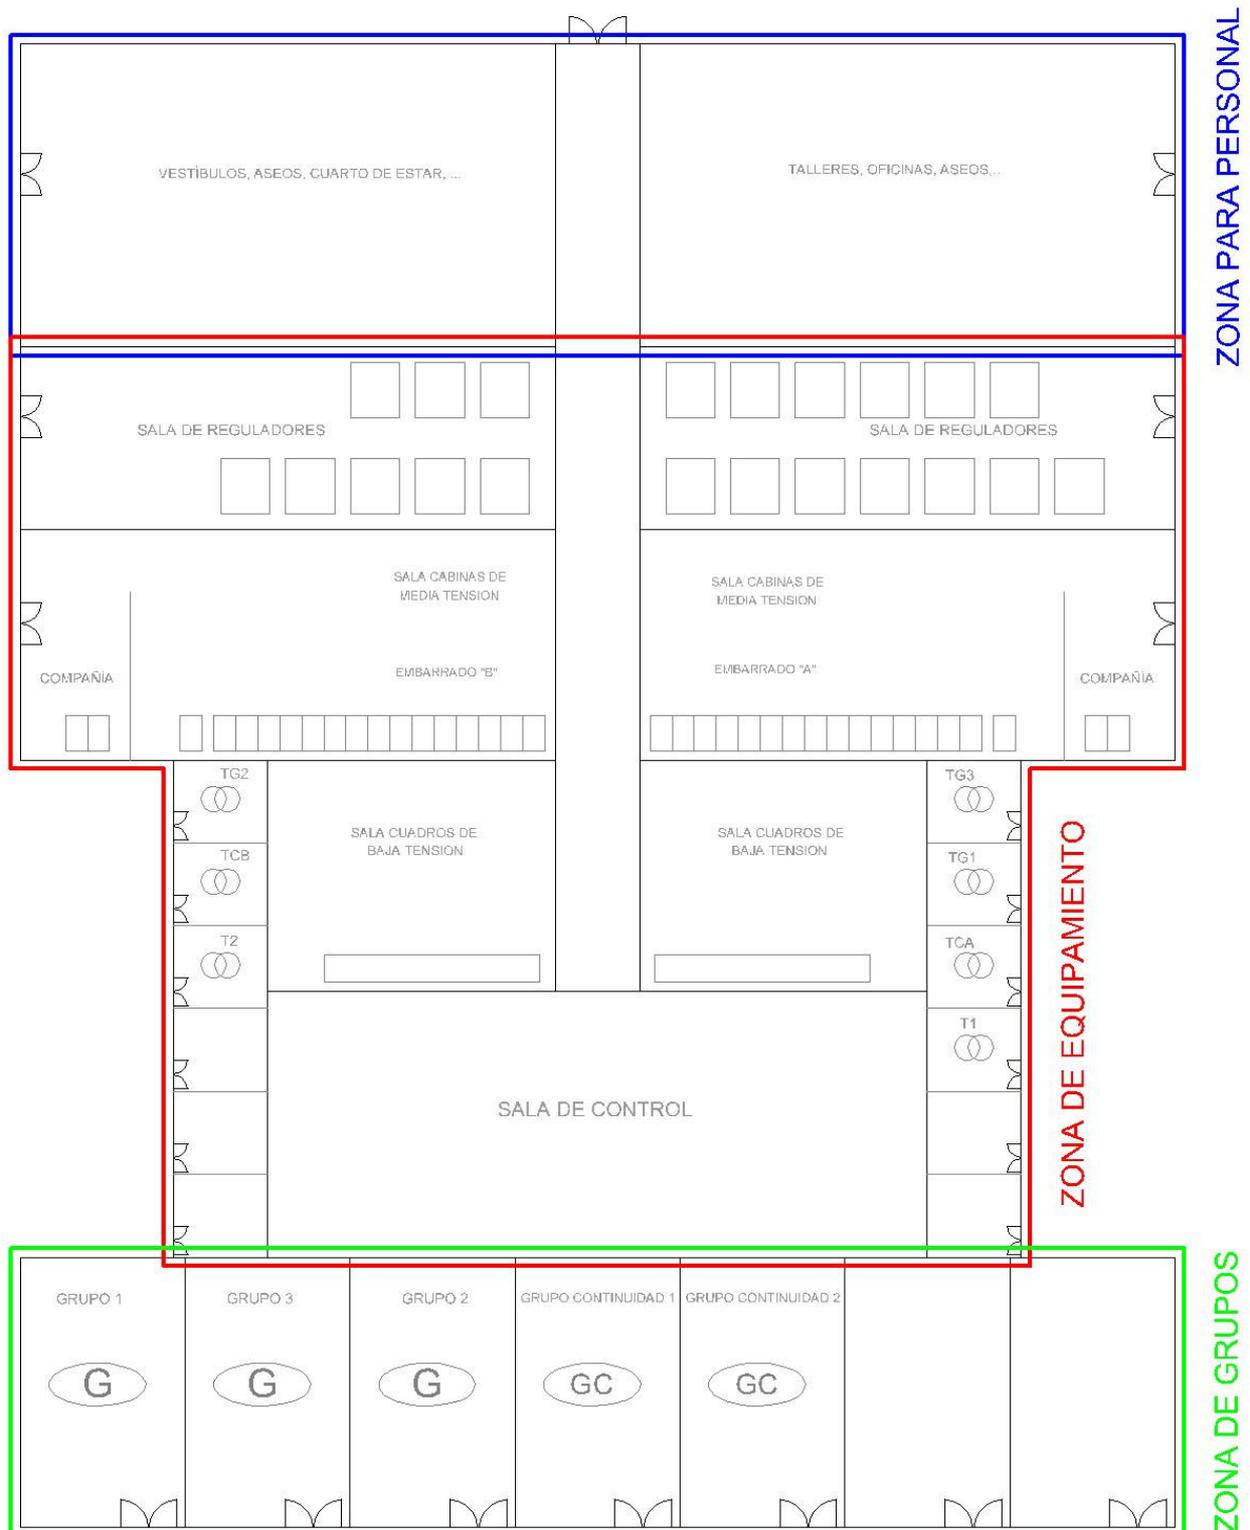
Figura XVI. Esquema de usos en planta de la Central Eléctrica. Estado proyectado.
